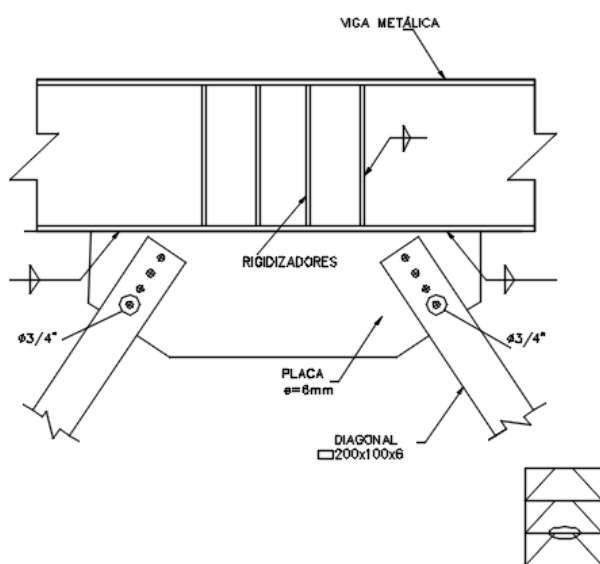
Detalle de elementos empleados para conexión tipo 2
